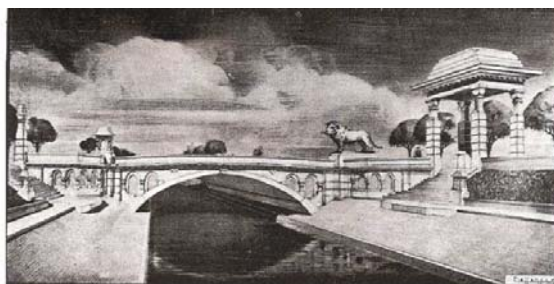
Projeto do Plano de Gladosch para a Ponte da Avenida Santana.
